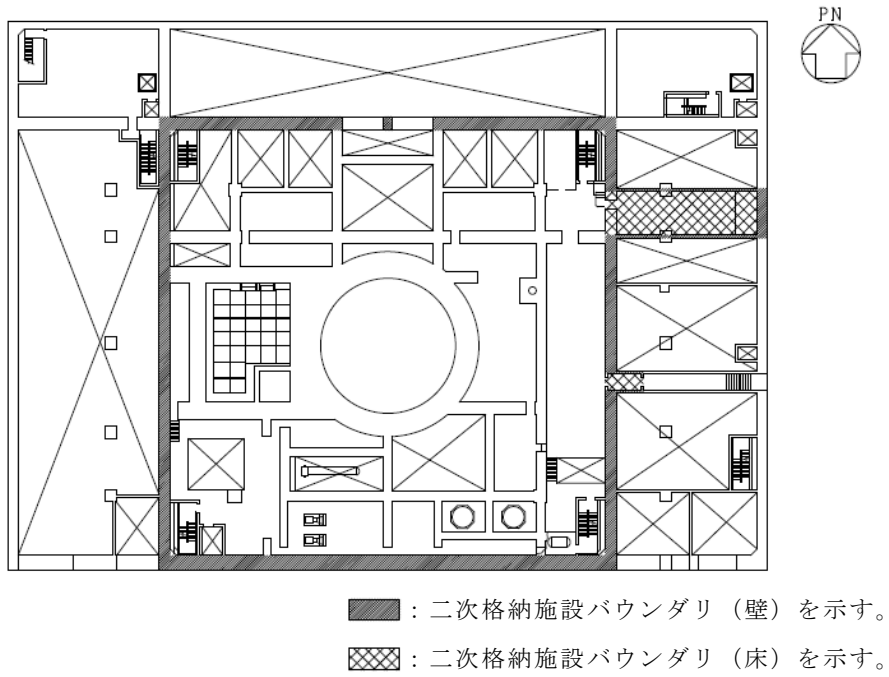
(7) 原子炉建物原子炉棟 (二次格納施設) の範囲の平面図
